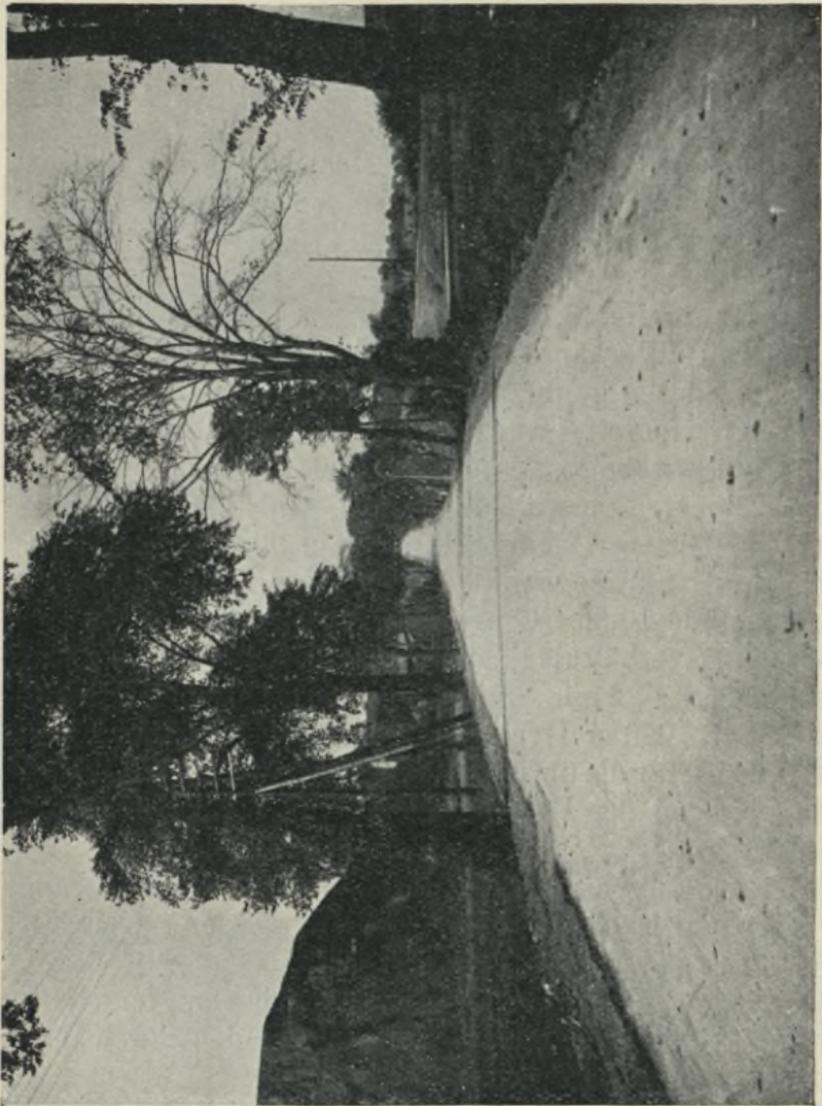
Betonstraße am Krummenweg bei Düsseldorf.
